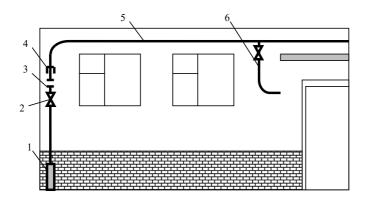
Ввод от фасадного газопровода в здание: 1 — футляр; 2 — запорное устройство; 3 — электроизолирующие фланцы; 4 — сгон; 5 — газопровод; 6 — опуск
